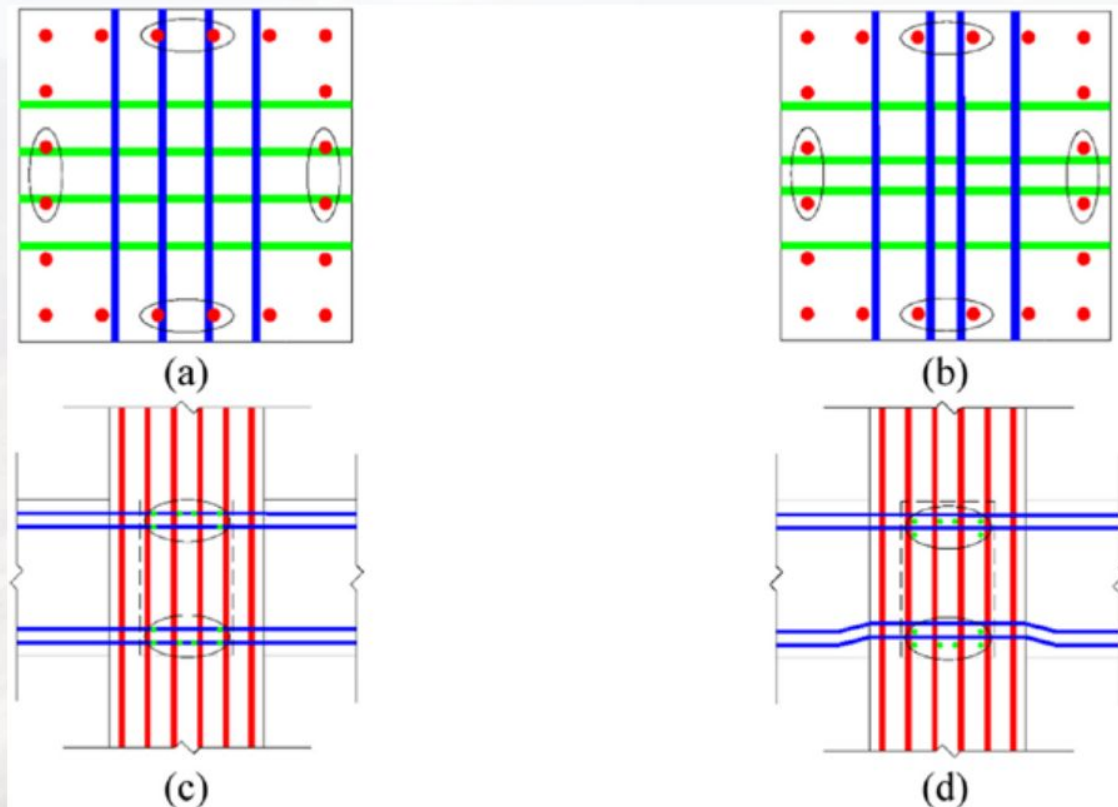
Elevación vertical de una junta: (a) Colisión de barras de refuerzo de columna con las de viga; (b) Colisión de barras de refuerzo de viga con las de columna; (c) Colisión de barras de refuerzo entre vigas; (d) Barras de refuerzo entre vigas acomodadas para evitar colisión. (Jiepeng L. et al., 2020)
